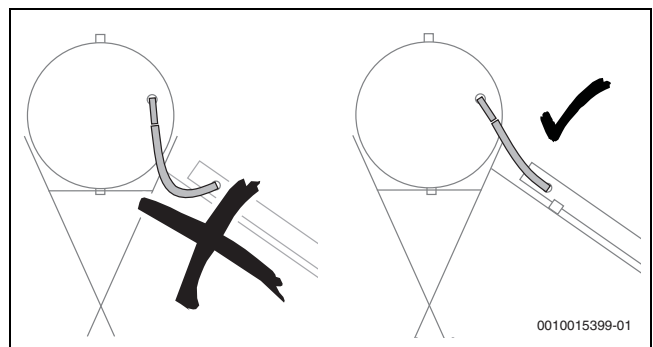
Não permitir qualquer bolsa na tubagem (aqui: tubagem de avanço)
